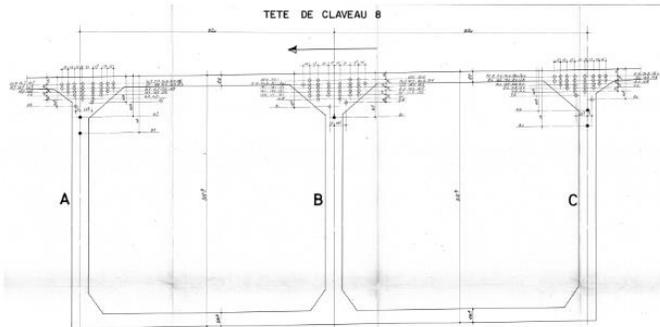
Position des câbles de fléau au droit de la tête de claveau n°8 - Extrait du plan « 78 - 14.938 B - Superstructure des 3 travées centrales - Tête de claveau 8 et 8' - Coffrage, câblage et armatures »
